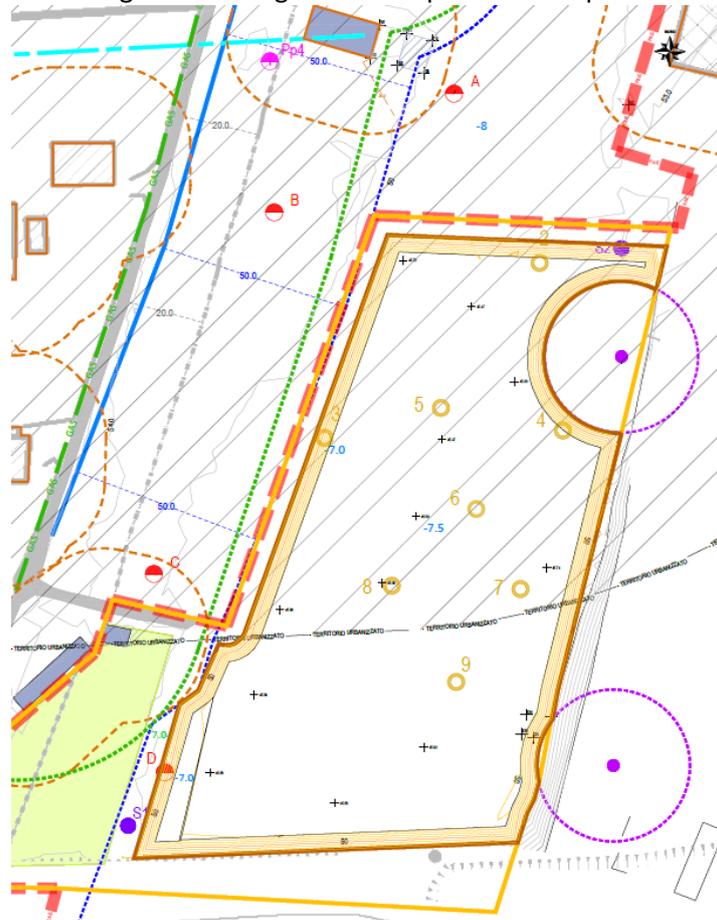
Planimetria degli scavi (scenario 1) estratto dalla Tavola C1
